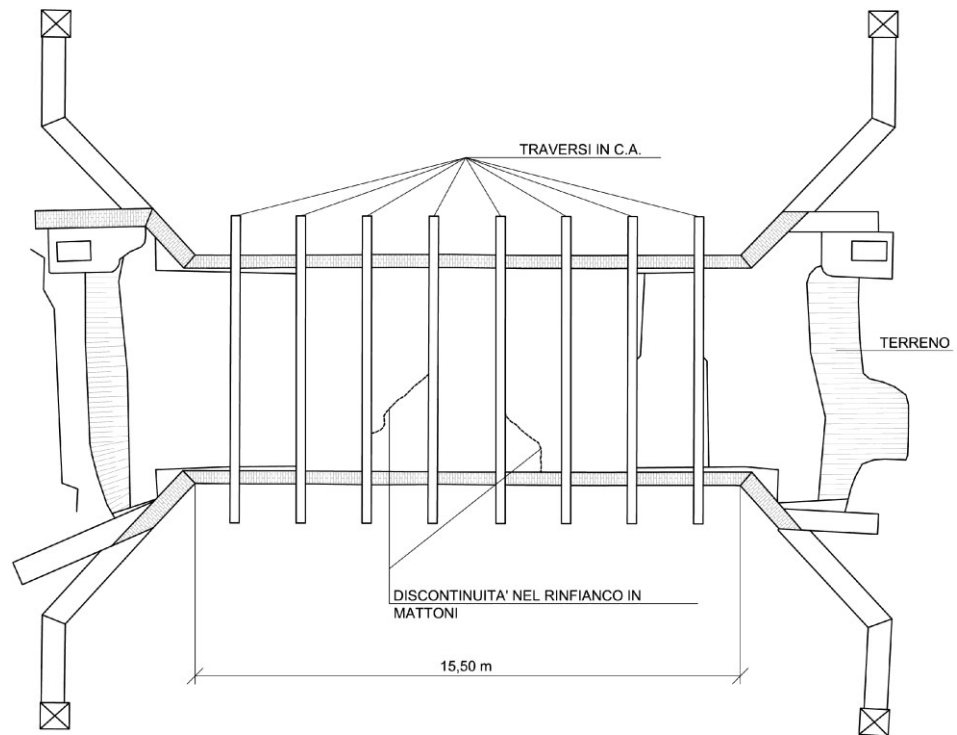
Pianta del ponte – elementi sotto il pacchetto stradale
